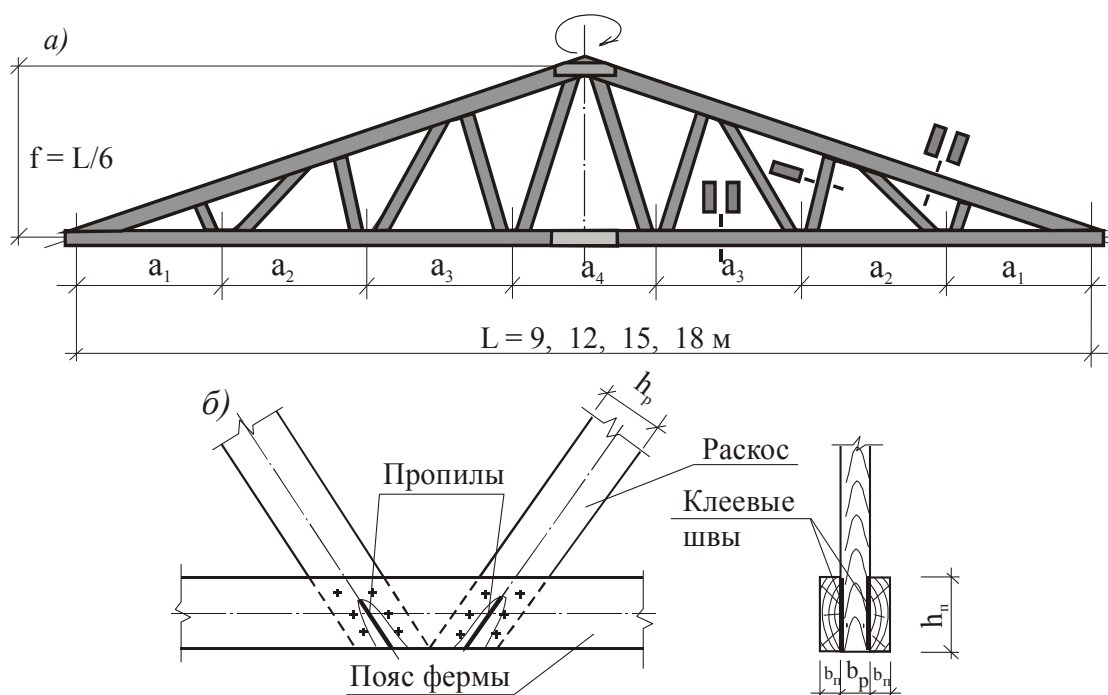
Ферма с бесфасоночными узлами: а – конструкция фермы, б – промежуточный узел фермы
